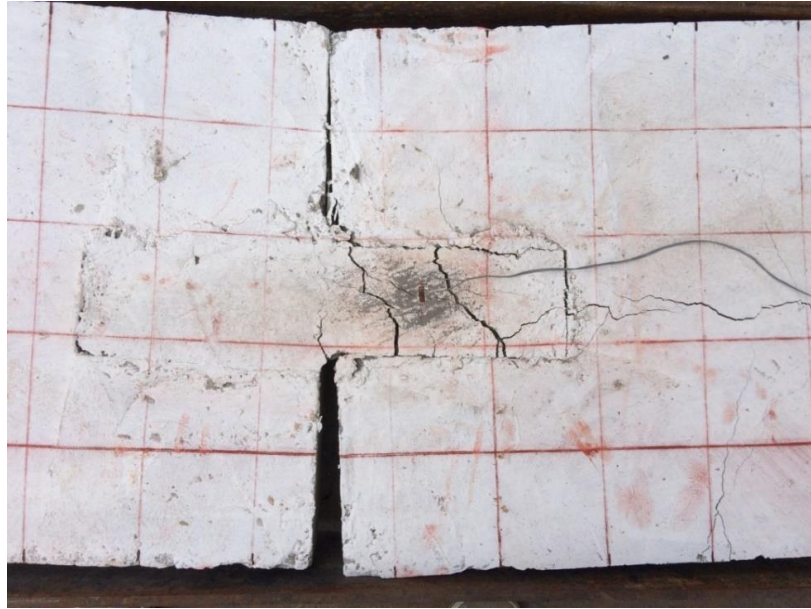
Fisuración transversal en conexión con carga normal a su plano.
